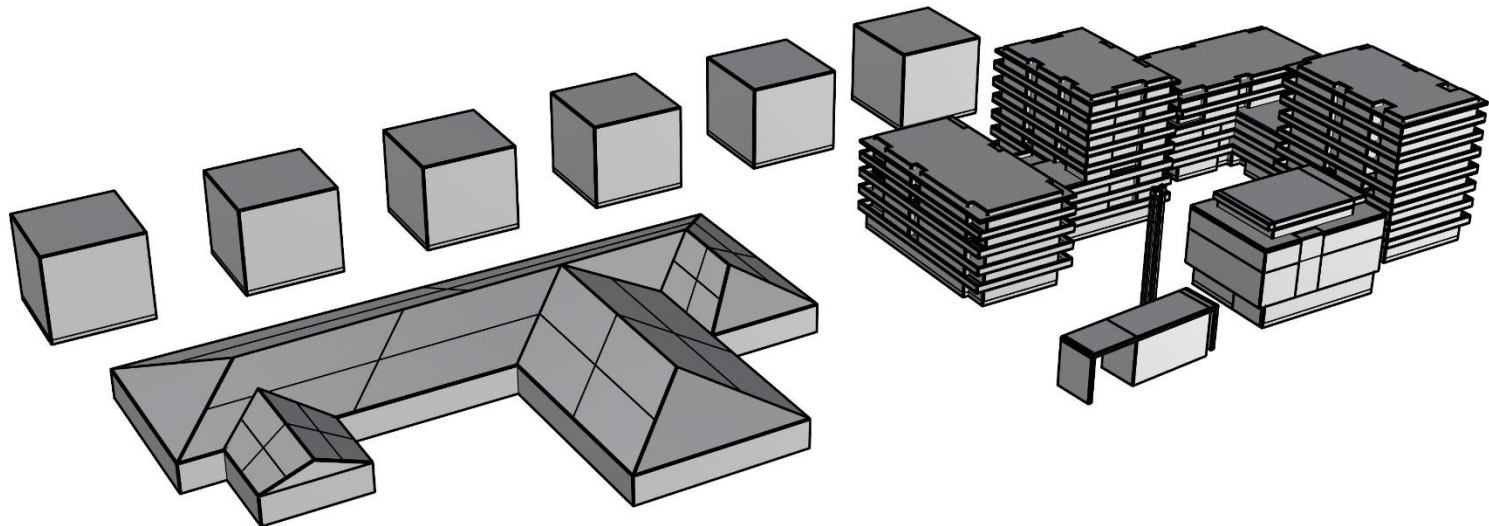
3D-Modell der geplanten Bebauung an der Römerstraße 67 mit bereits bestehendem Blockheizkraftwerk und Nachbarbebauung
